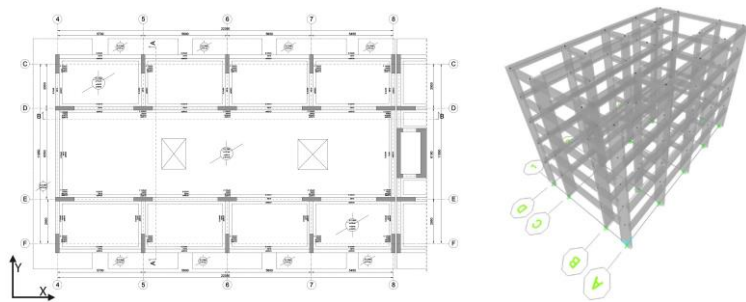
Pianta strutturale del piano tipo e immagine del modello a elementi finiti.
